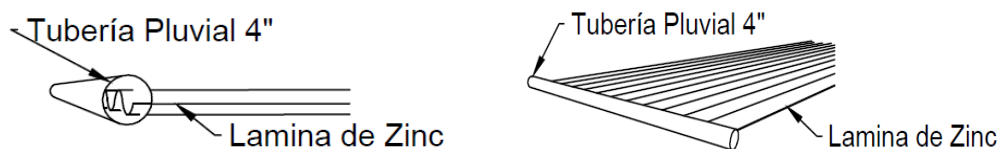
Detalle instalación tubería pluvial 4" en lámina de zinc.
